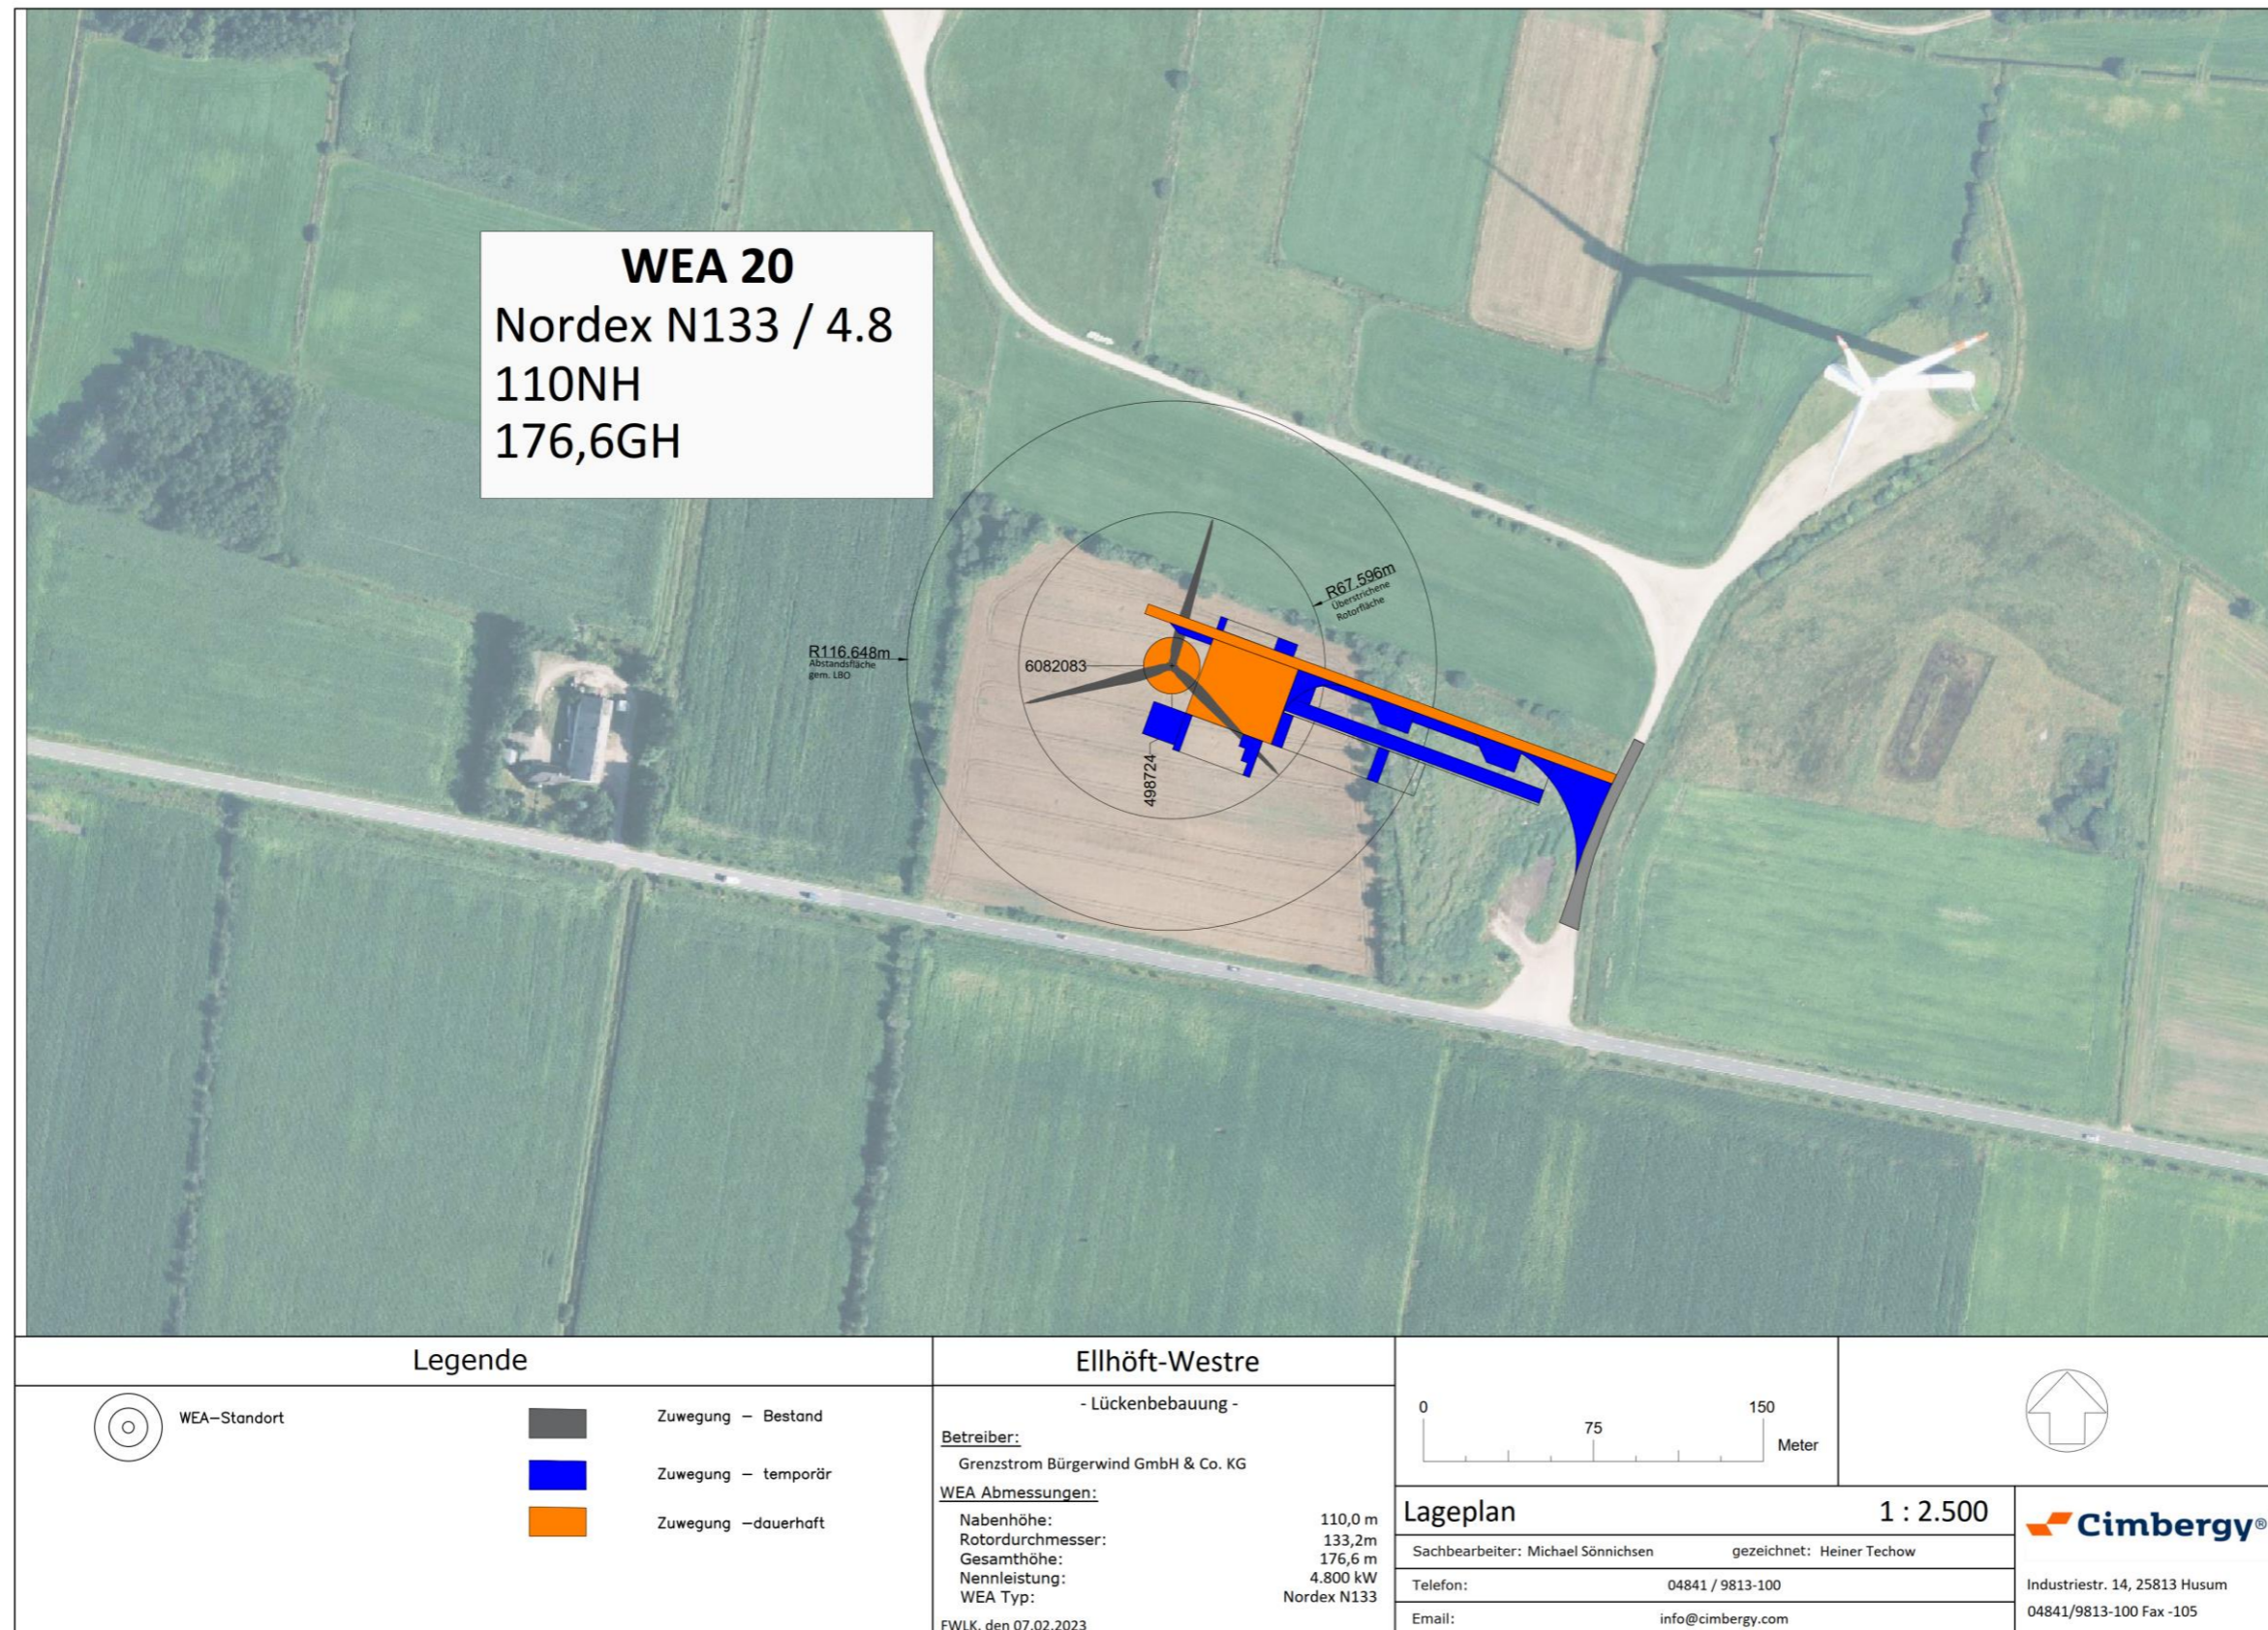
Planlægning af placering og adgang VEA 20 (Kilde: Cimbergy; sidst ændret: 08-02-2023)
